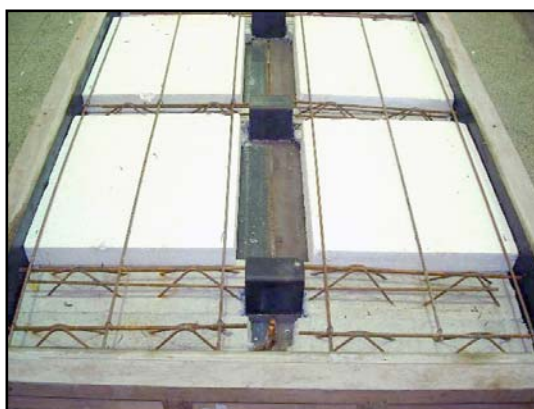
Viga metálica com laje treliçada estudada por David (2007)
